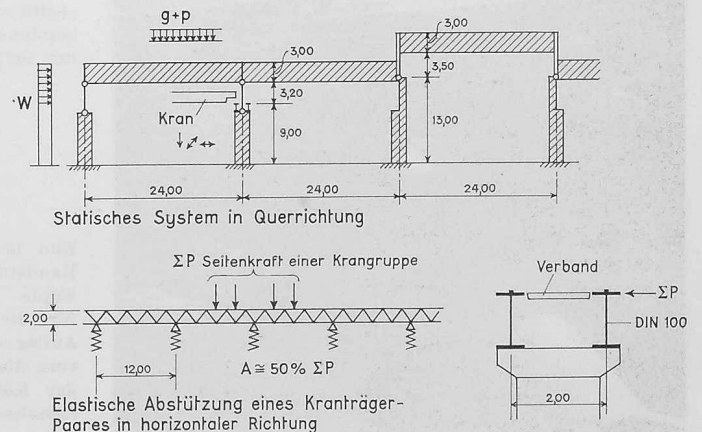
Statisches System der Giessereihallen (Stahlkonstruktion)
